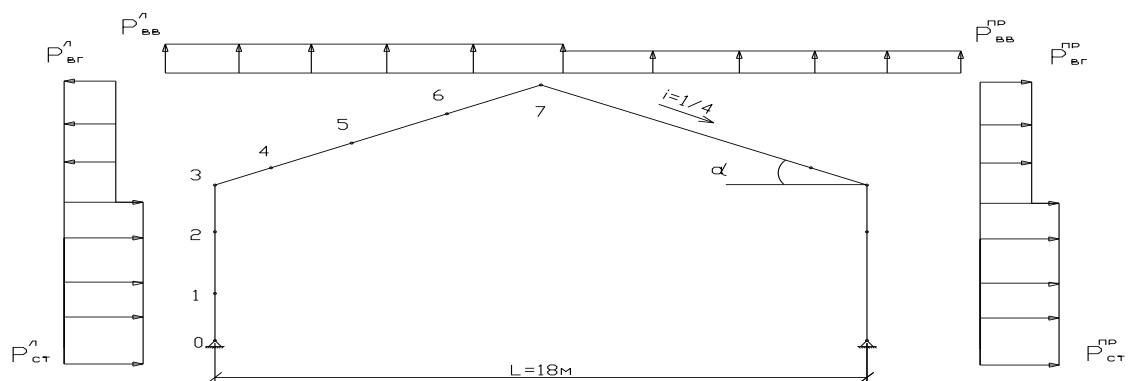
Расчетная схема рамы с характерными точками, для расчета ветровой нагрузки
